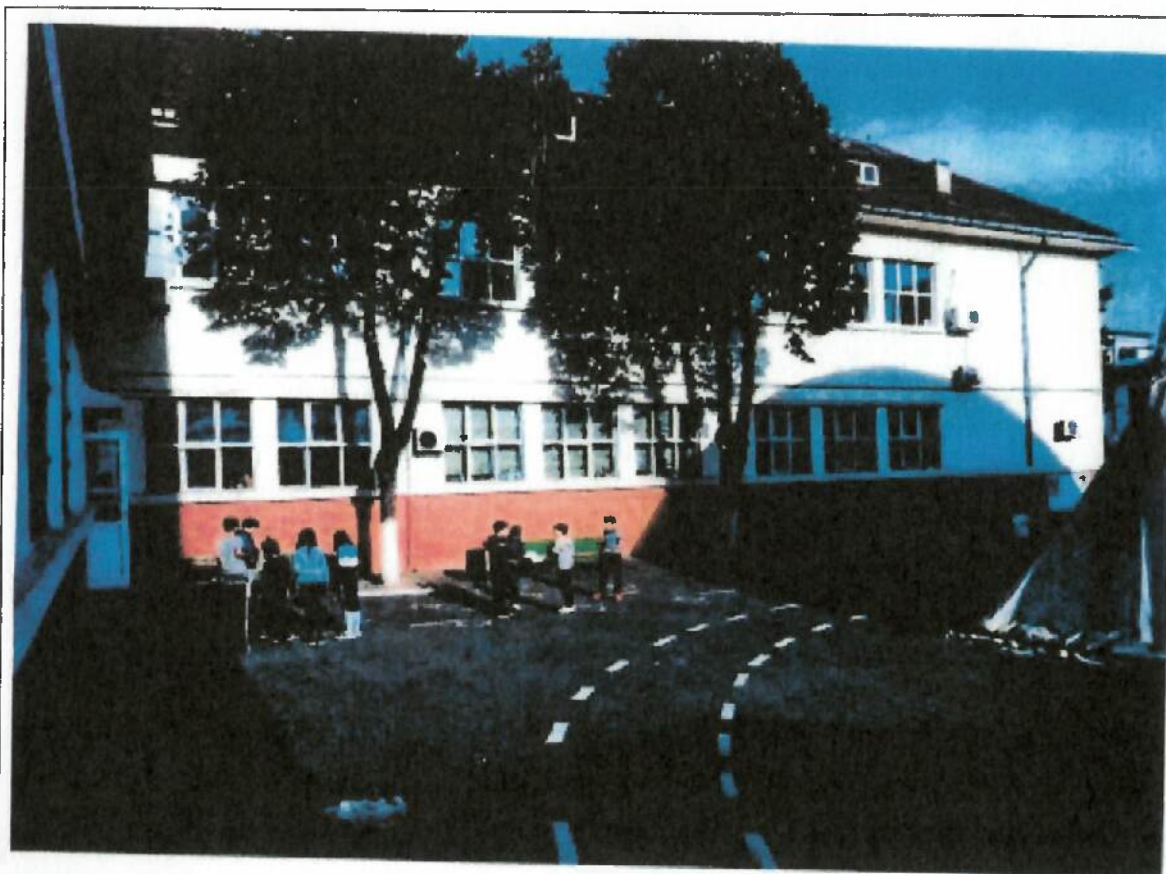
Situație existentă – Vedere laterală Corp C1 – Tronson B
